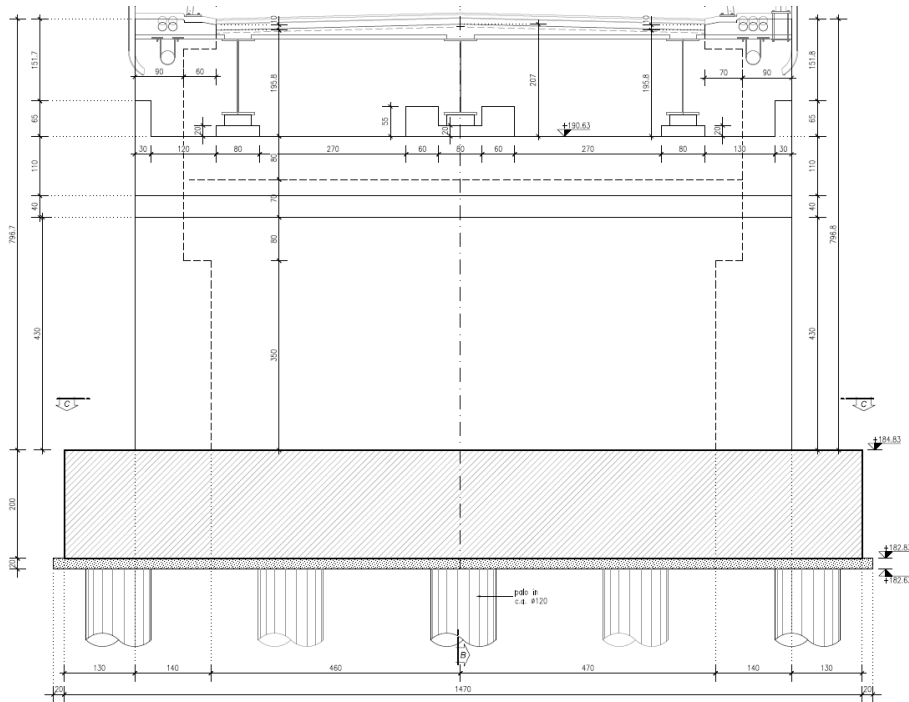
Prospetto del paramento frontale della spalla A
